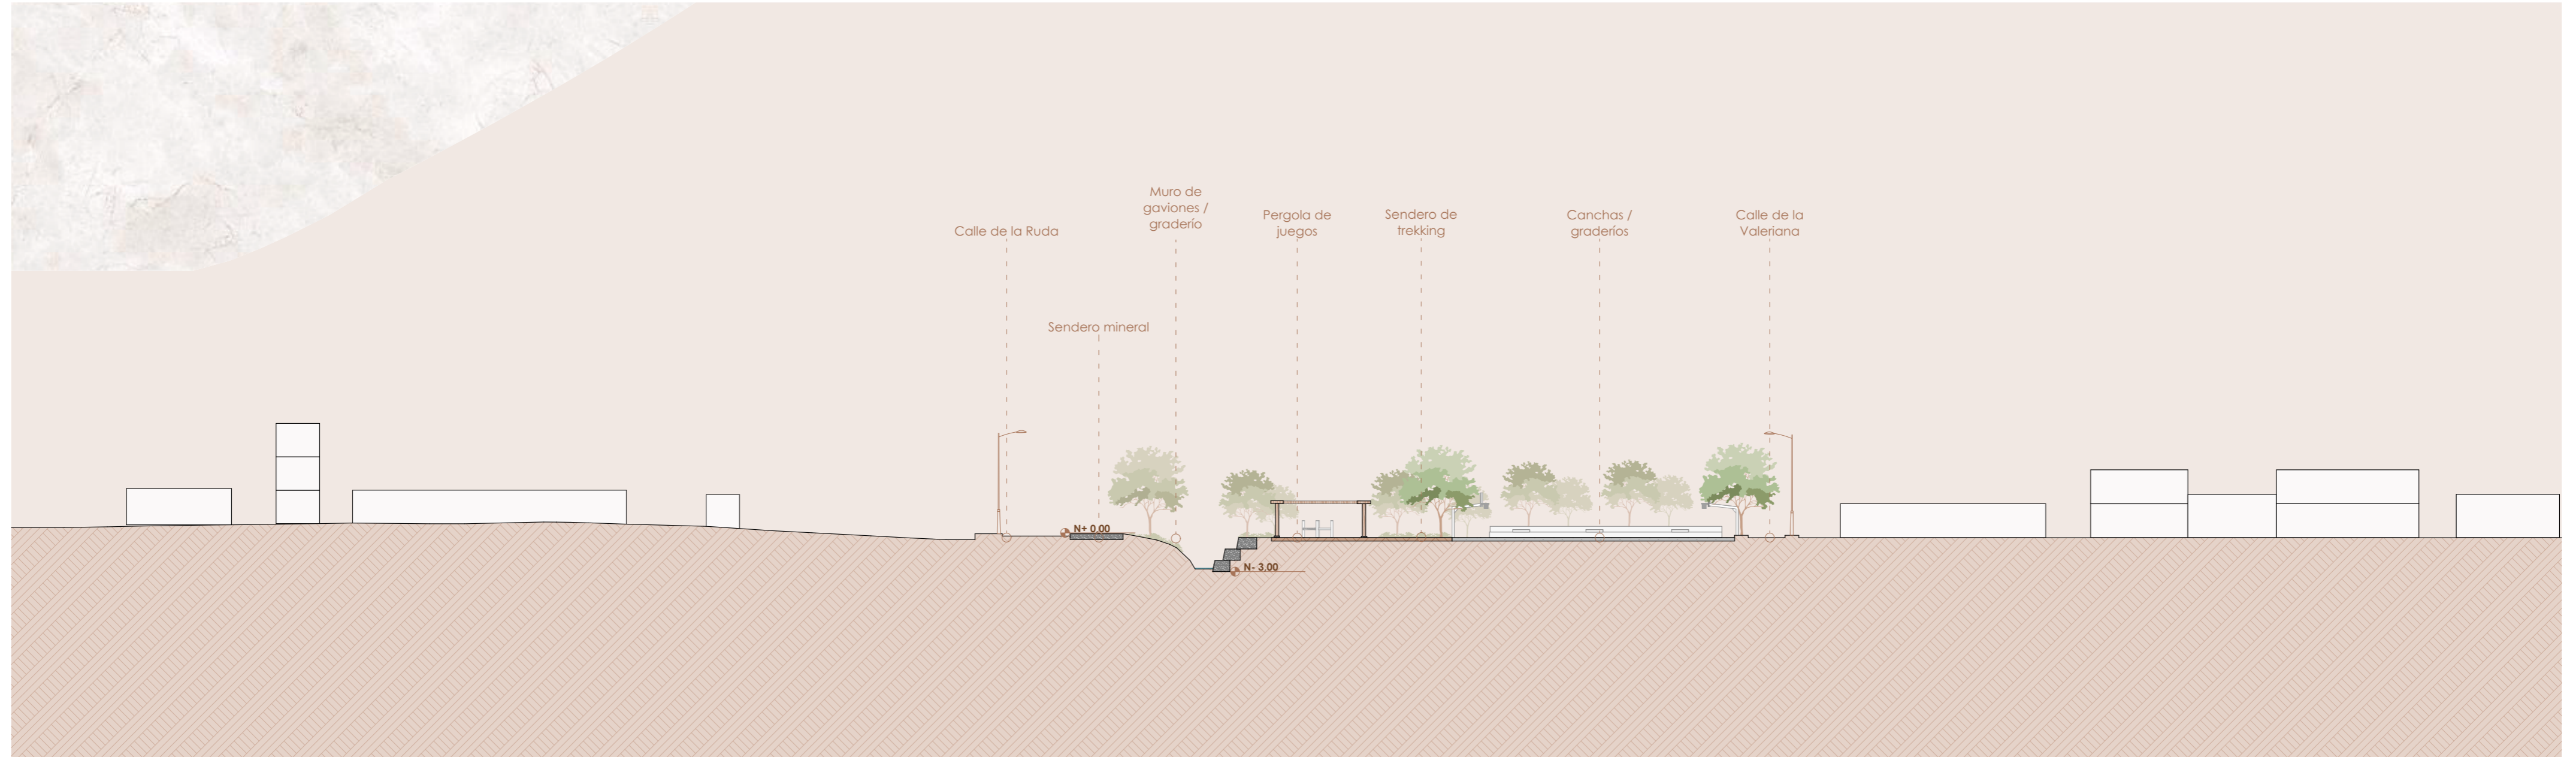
Sección 4 - parque lineal. Fuente: Autoría propia (2026).
